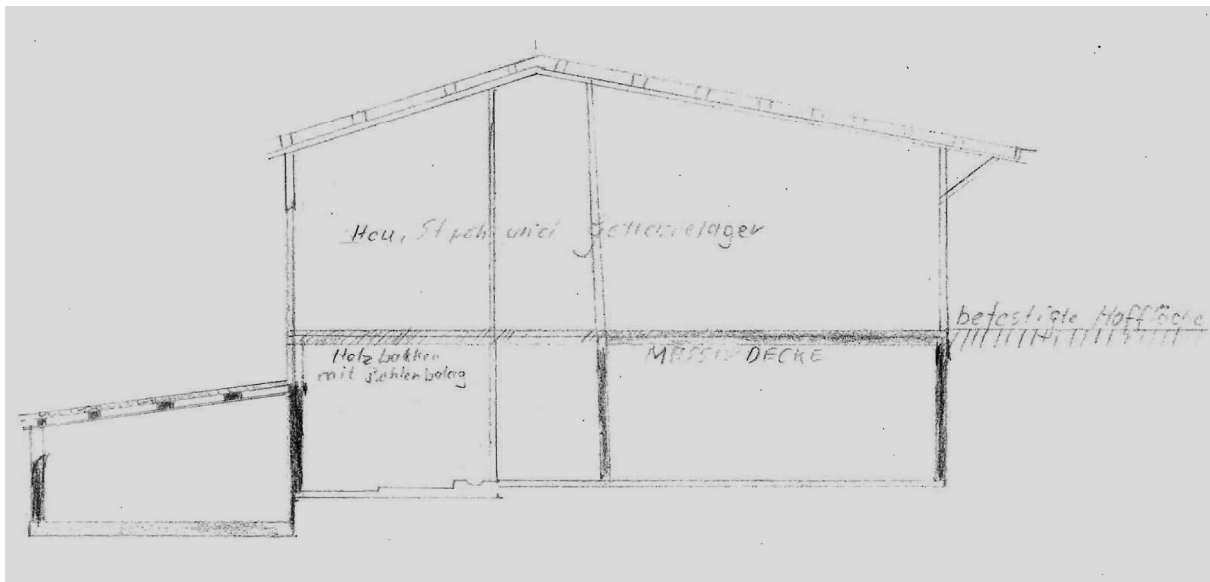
Gebäudequerschnitt Hauptstall- und Lagergebäude (Quelle: Betriebsunterlagen 'Lenspacher Hof', 1975)
